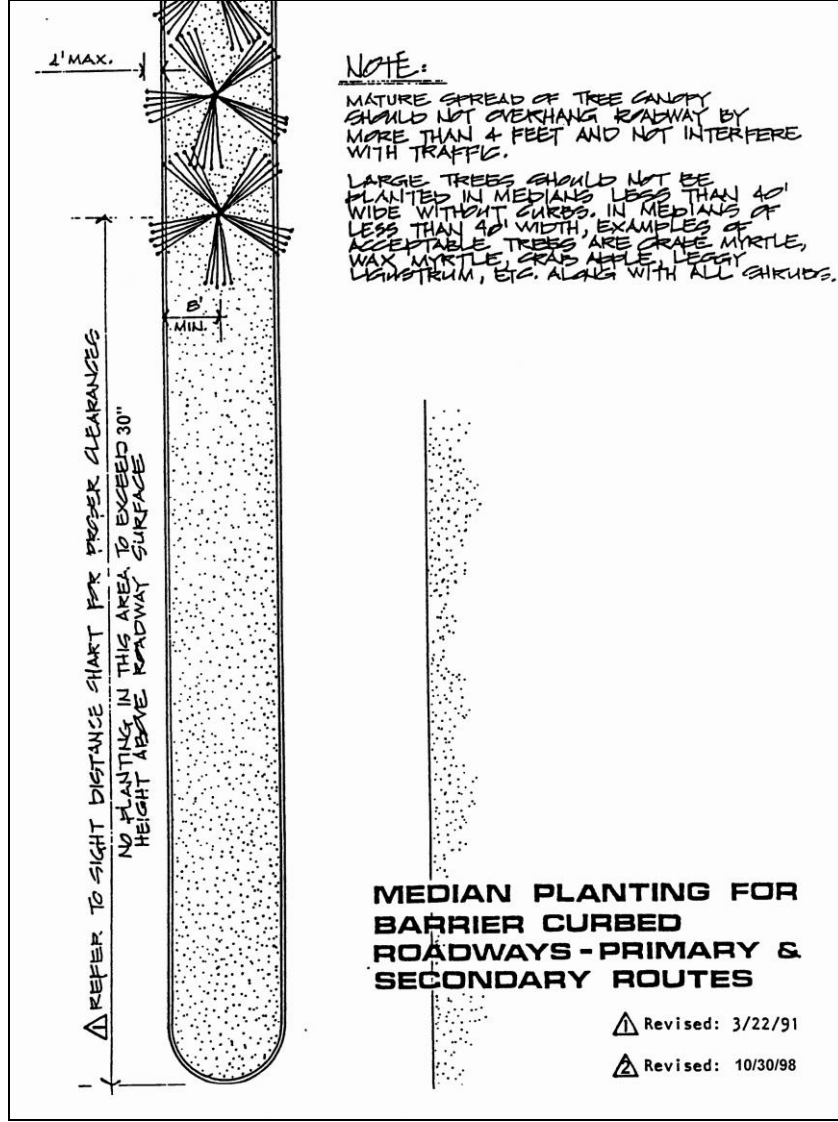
Tipik orta refüj bitkilendirmesi (Highway 99 Beautification Master Plan, 2000).
